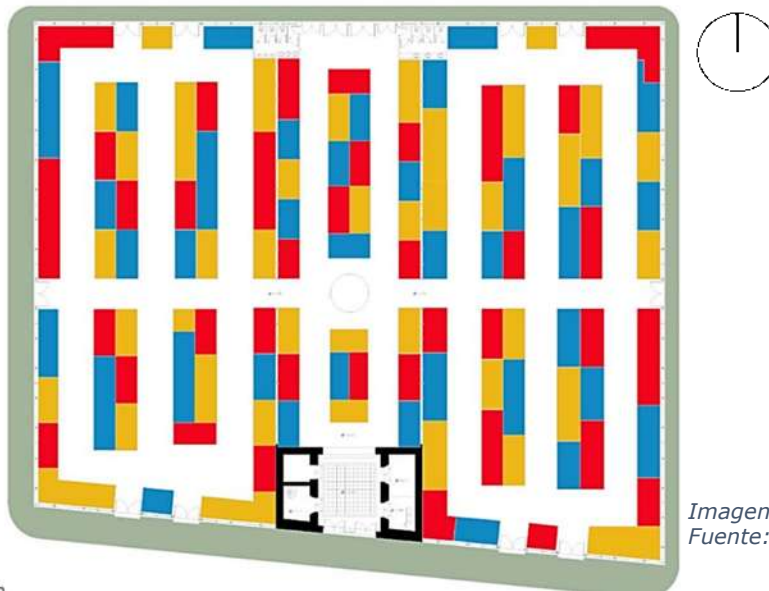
Planta arquitectónica del Mercado. Fuente: Archdaily.
